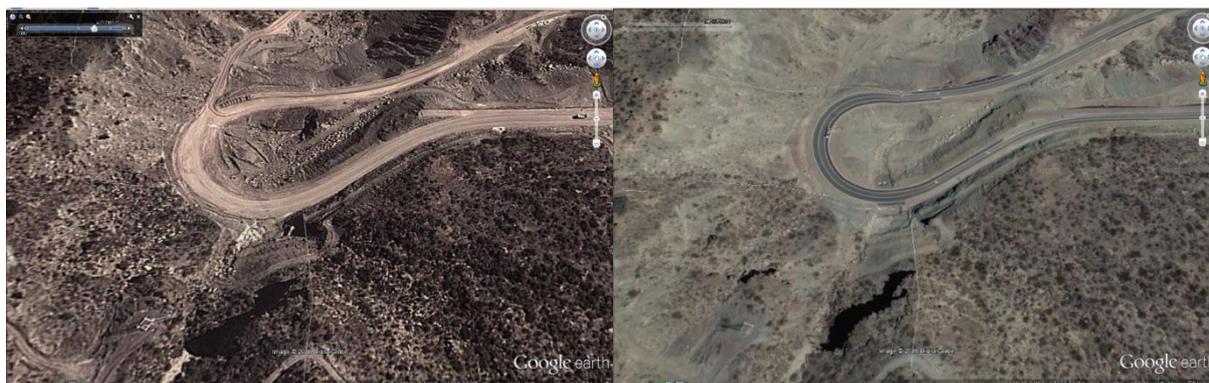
Fotos de la zona en dos etapas de construcción.
